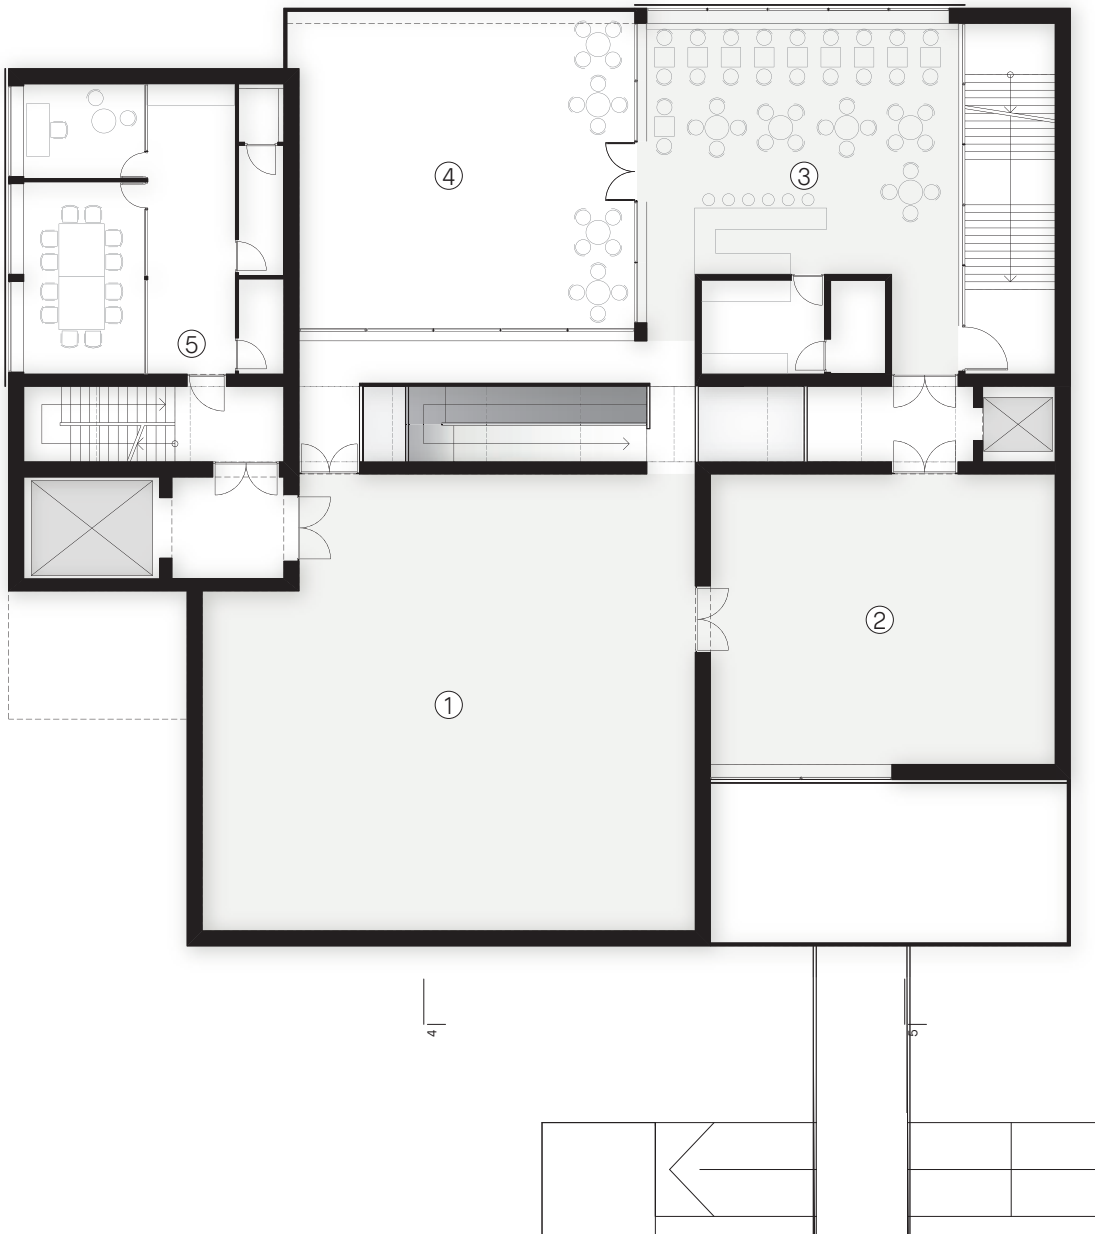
(linke Seite), 42 Grundrisse
